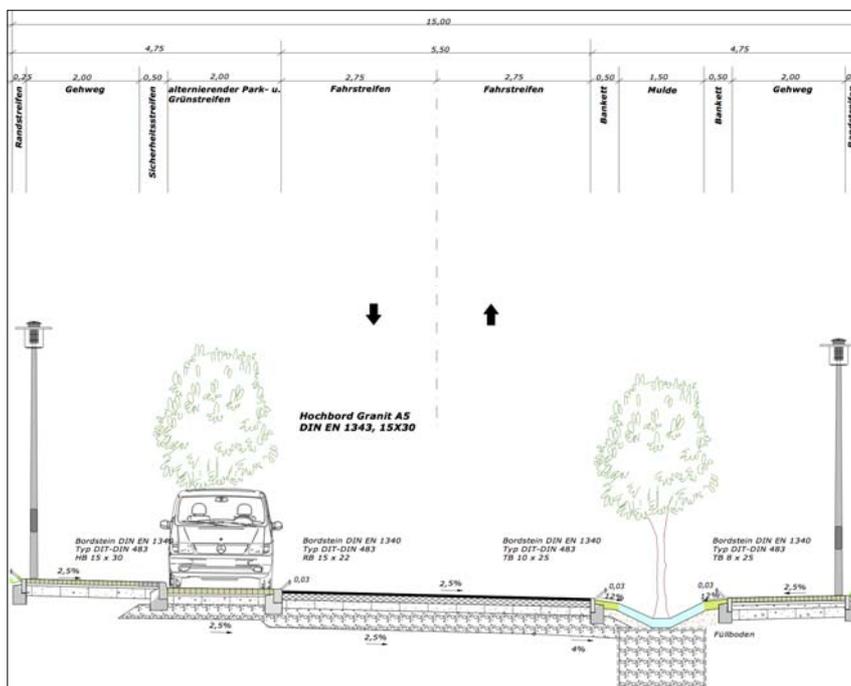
Prinzipquerschnitt der Planstraße B (15 m)
